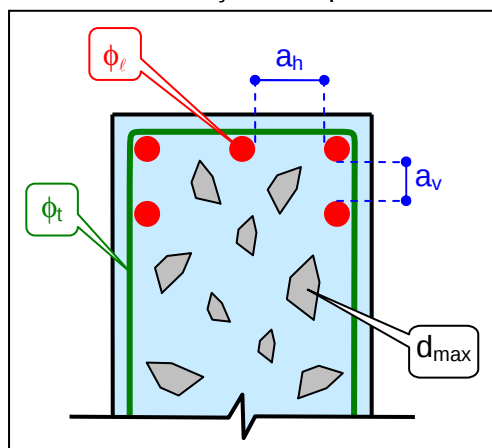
Espaçamento horizontal e vertical de barras longitudinais
